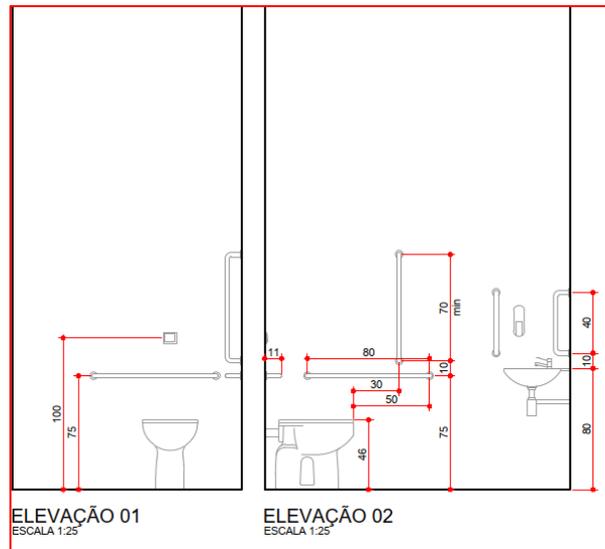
Detalhe de Projeto - Fonte: CEASA/PR e ARCHSALLES
